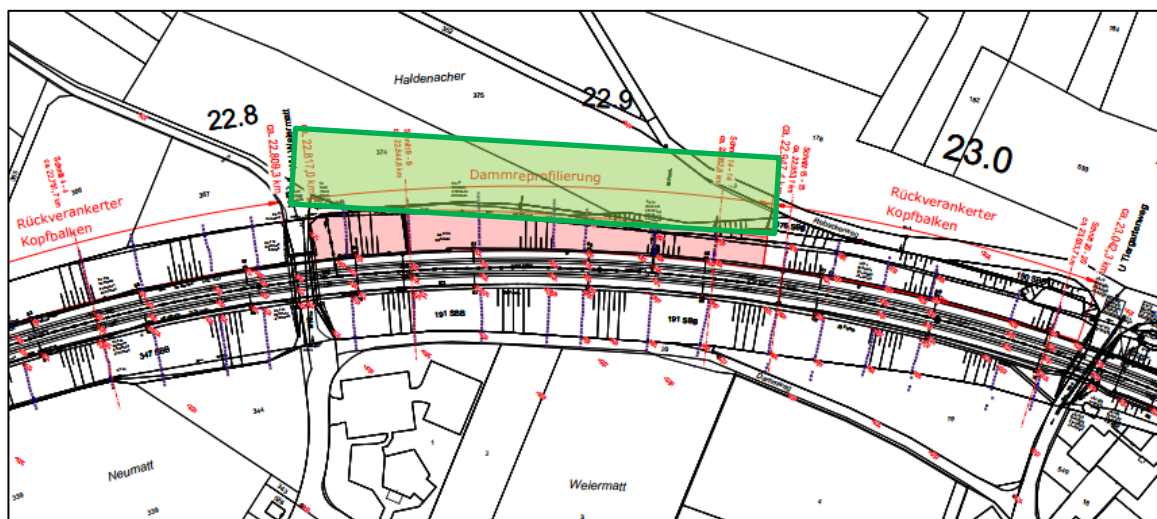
Vorübergehende Beanspruchung (Grüne Markierung)
